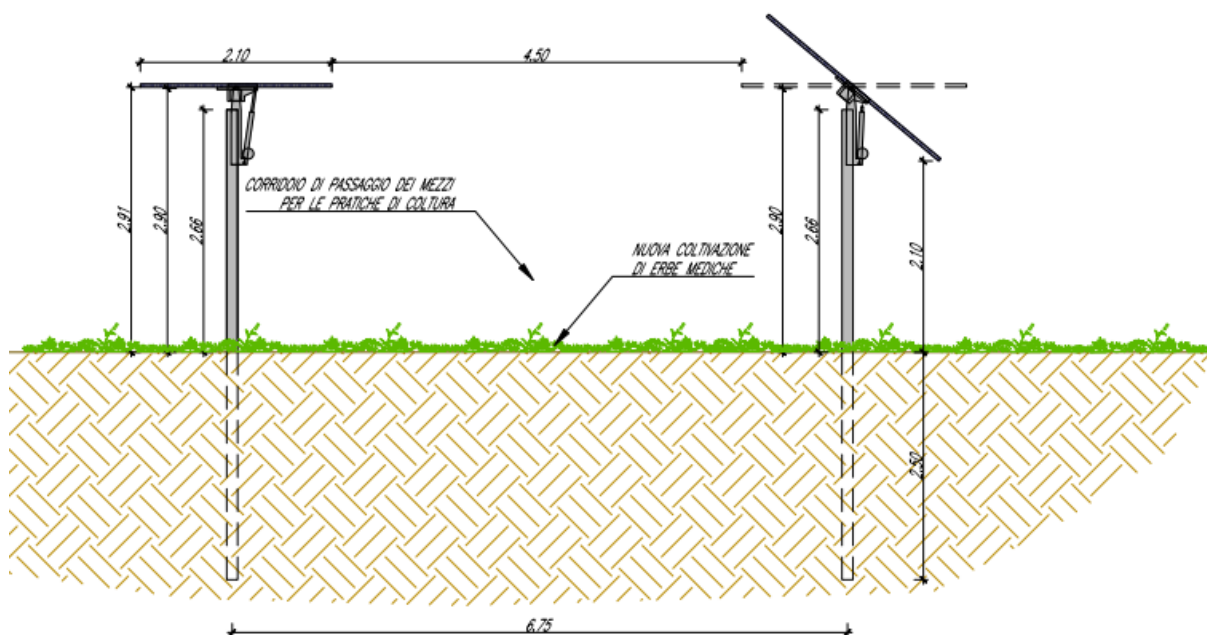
Sezione trasversale e dettaglio della mobilità dei pannelli fotovoltaici.
